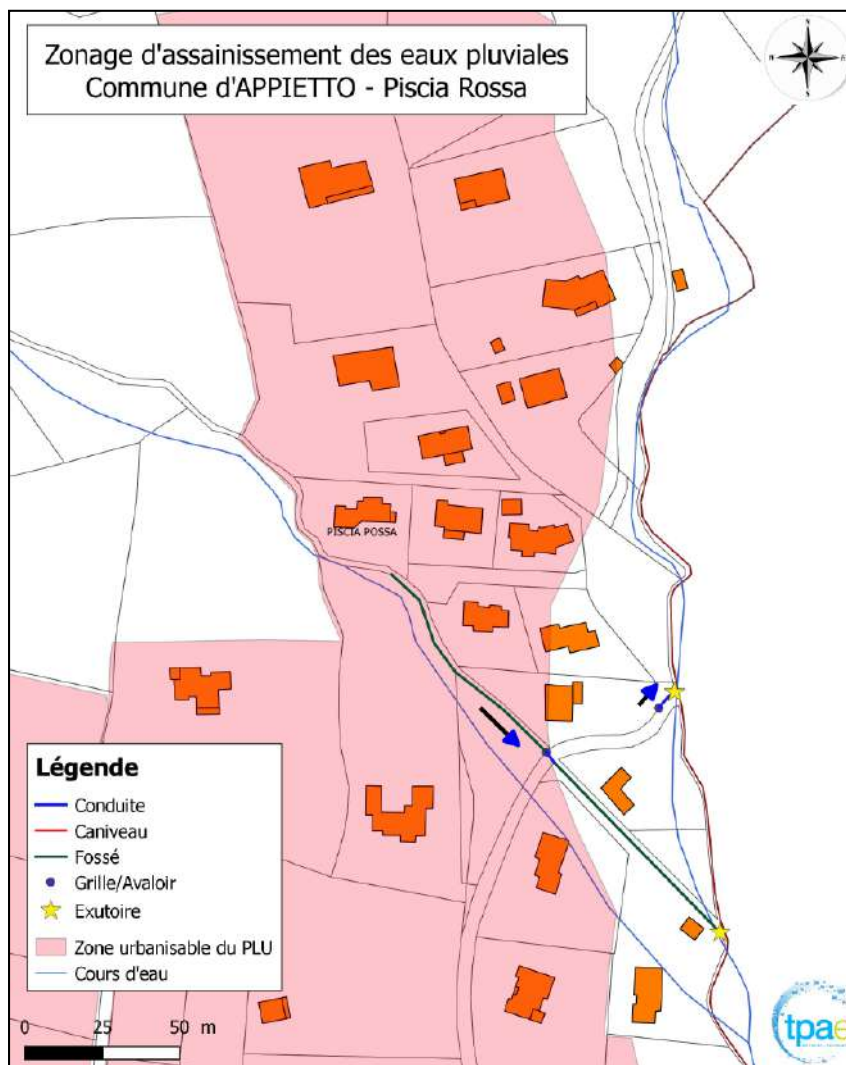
Plan du réseau pluvial du hameau de Piscia Rossa
